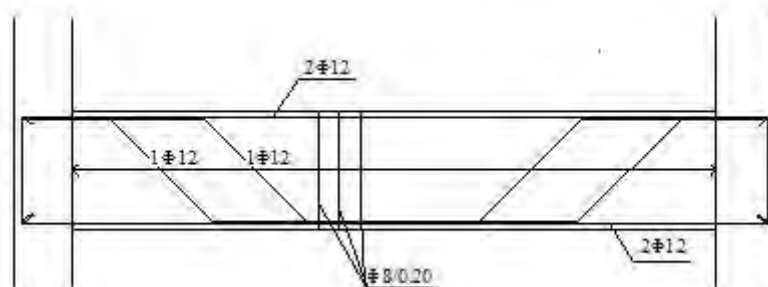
Pormenor da armadura nas vigas, adaptado de Fardis (2002).
